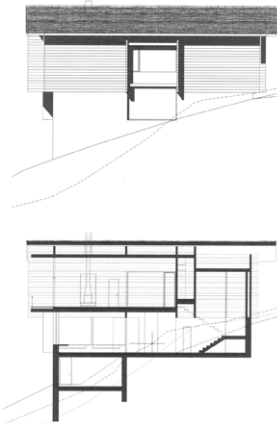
Detalle del escalonado de los maderos para salvar la pendiente. Casa Annalisa
